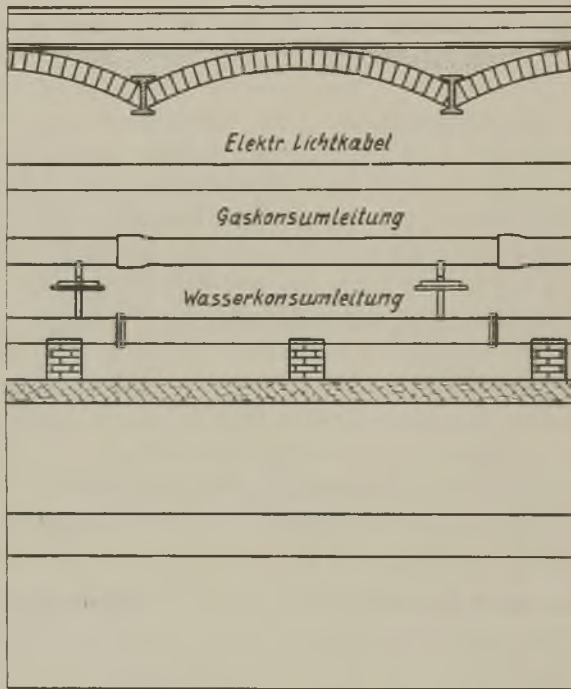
Längsschnitt durch einen Straßentunnel mit sämtlichen Leitungen.
